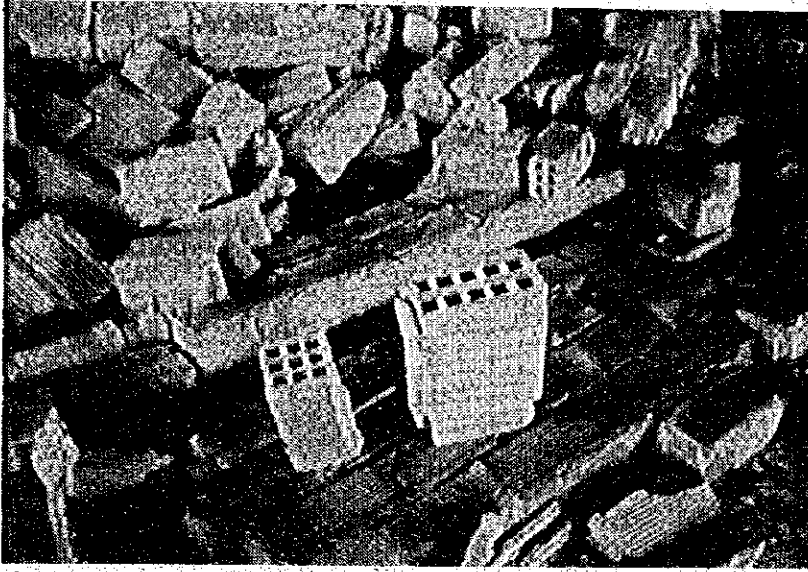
孔明き煉瓦は壁に多用されている。鉄筋コンクリートフレームの中に infilled-wall として用いられていることも多い。骨組との接合がないので多くは面外に崩れ落ちている。
